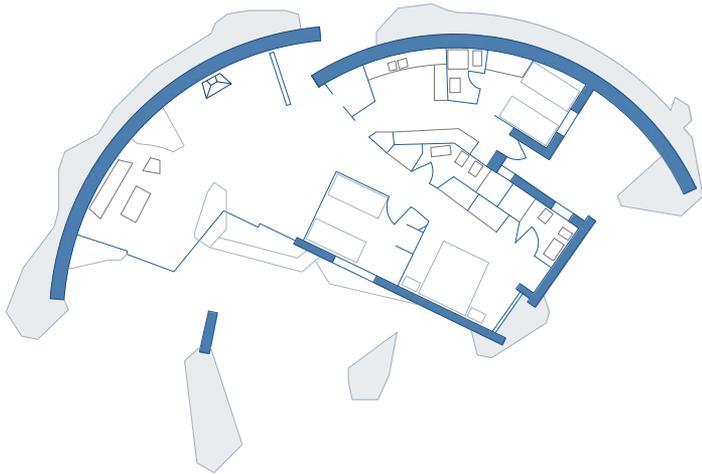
Planimetría Chalet Pérez del Pulgar. Elaboración propia.
